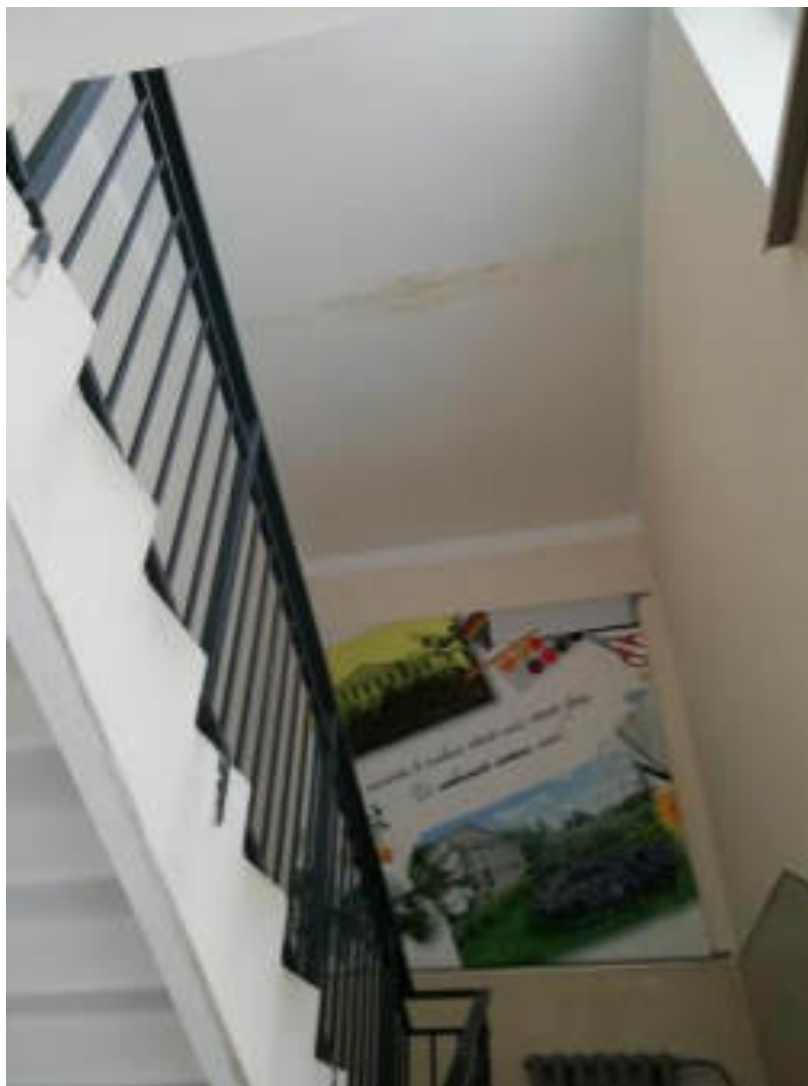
Лестница 3 корпус 2. Следы протечки на потолке, плоская кровля
